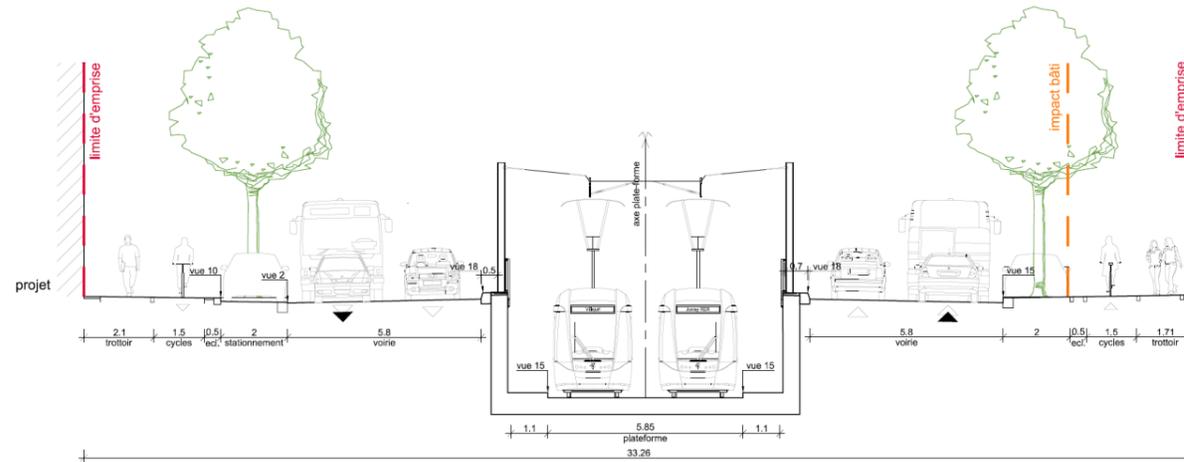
Coupe de la RN7 au niveau de la tranchée ouverte (trémie d'accès au souterrain)
